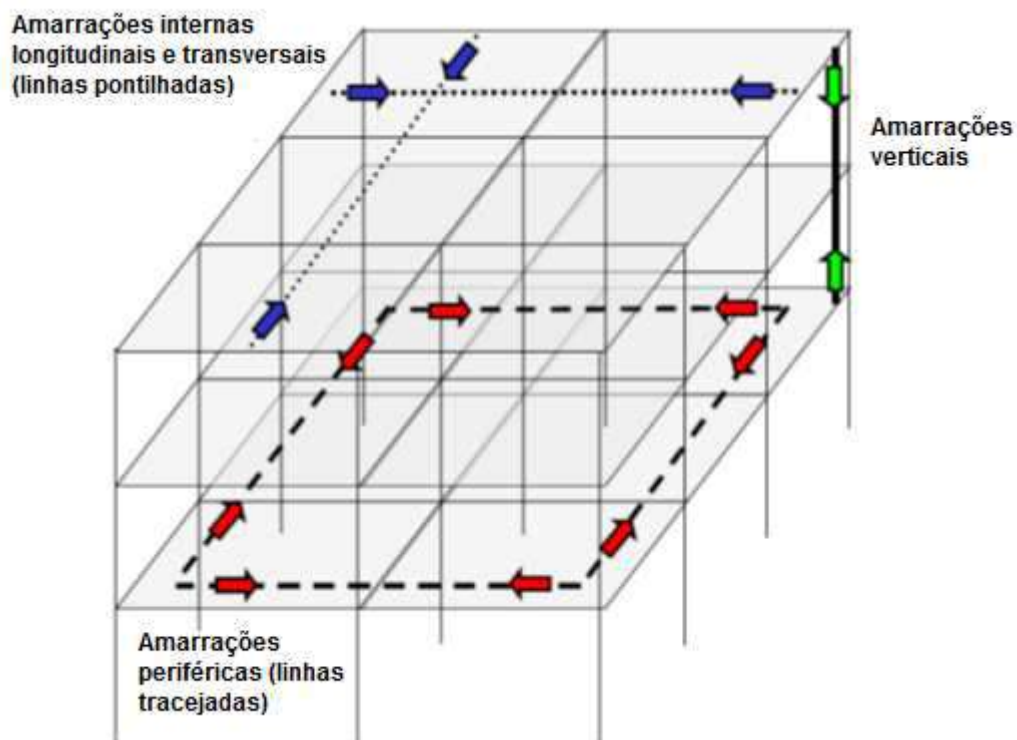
Diferentes tipos de amarrações que proveem integridade estrutural em estruturas a pórtico (adaptado de DOD, 2016)
